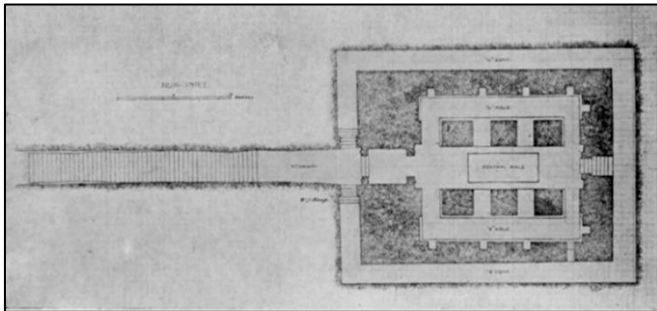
Planta de las cámaras subterráneas de Ku. 1 (Taharqo).
